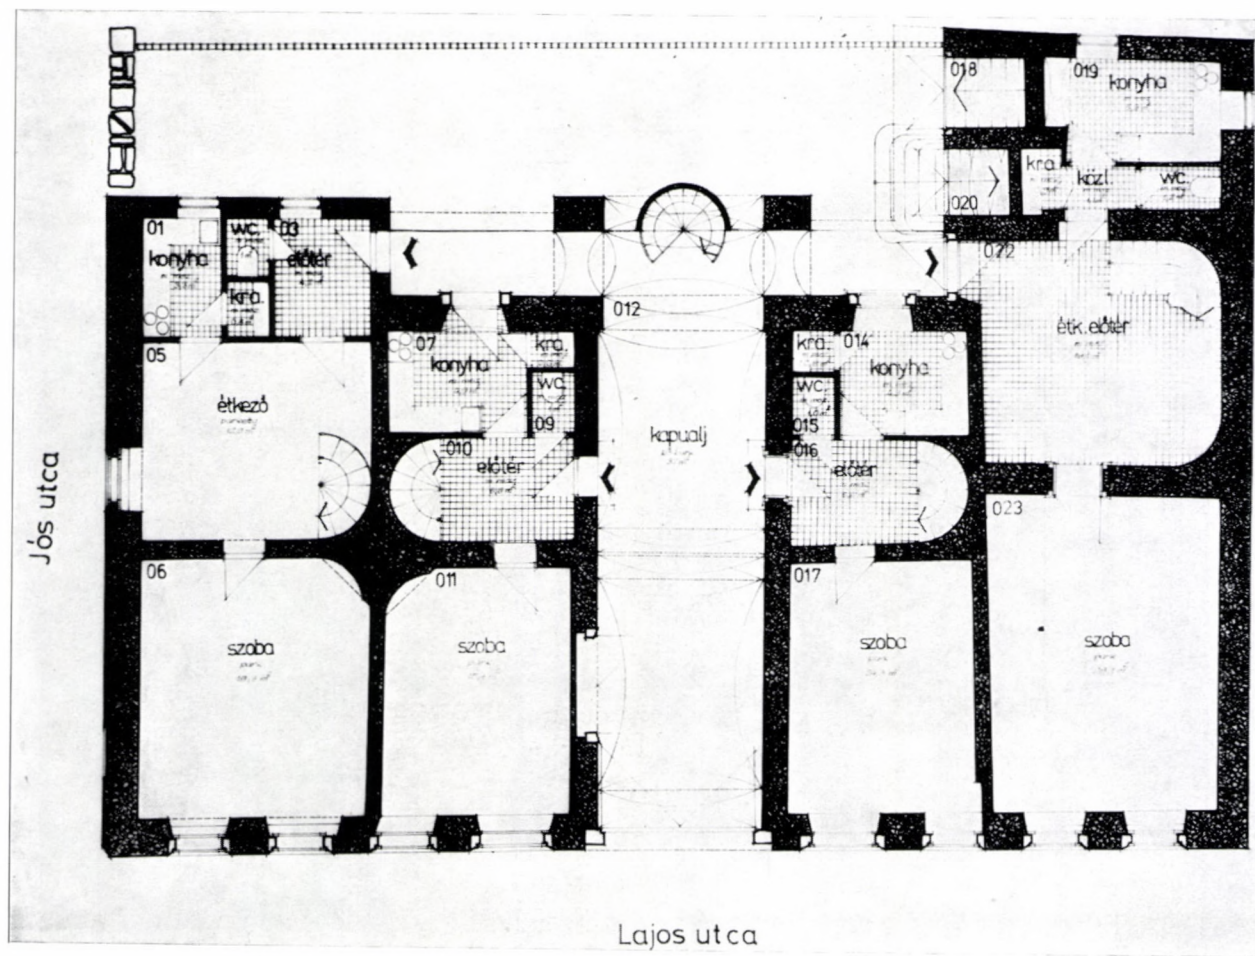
Lajos-Gasse Nr. 152 Restaurierungsplan, Grundriß des Erdgeschosses
